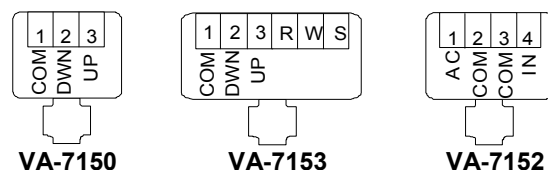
Тип привода и маркировка клемм (См. VEIMS 45-2.03-2)
